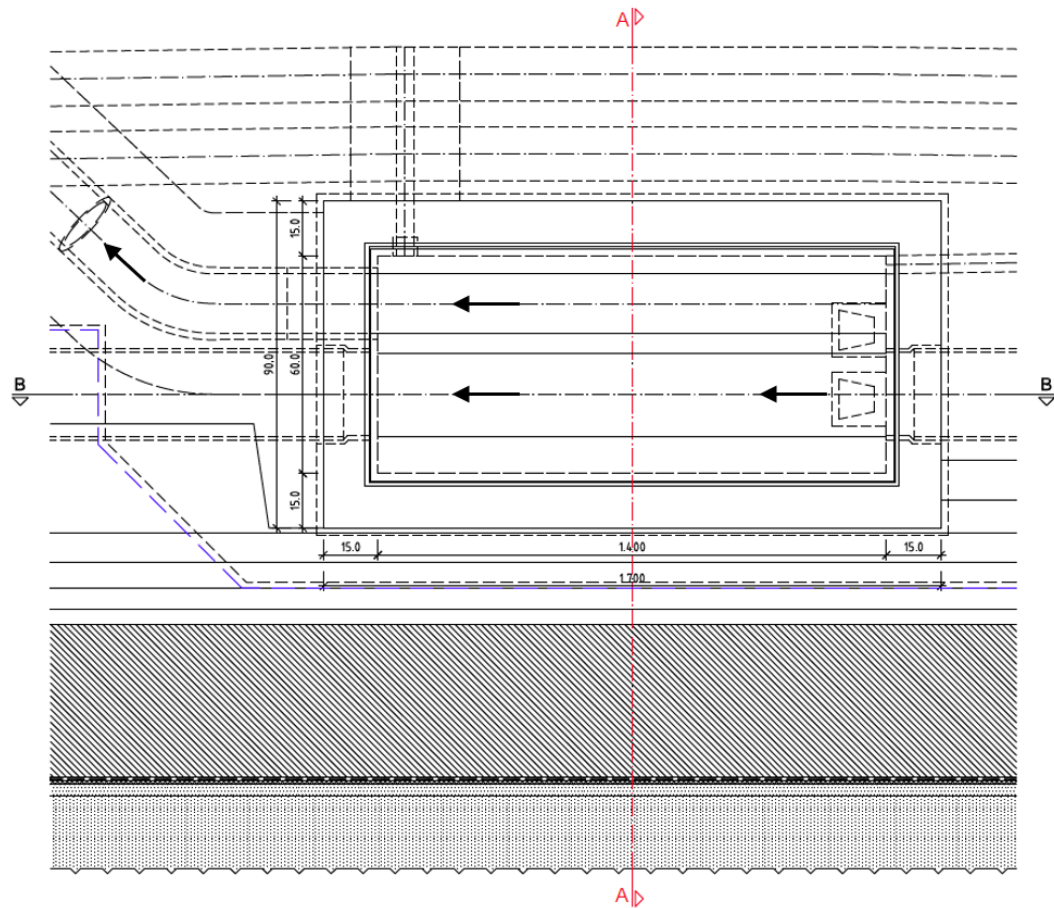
Grundriss Ausleitung Putzschacht Ulmendrainage laut Ausschreibungsplanung<sup>1</sup>
